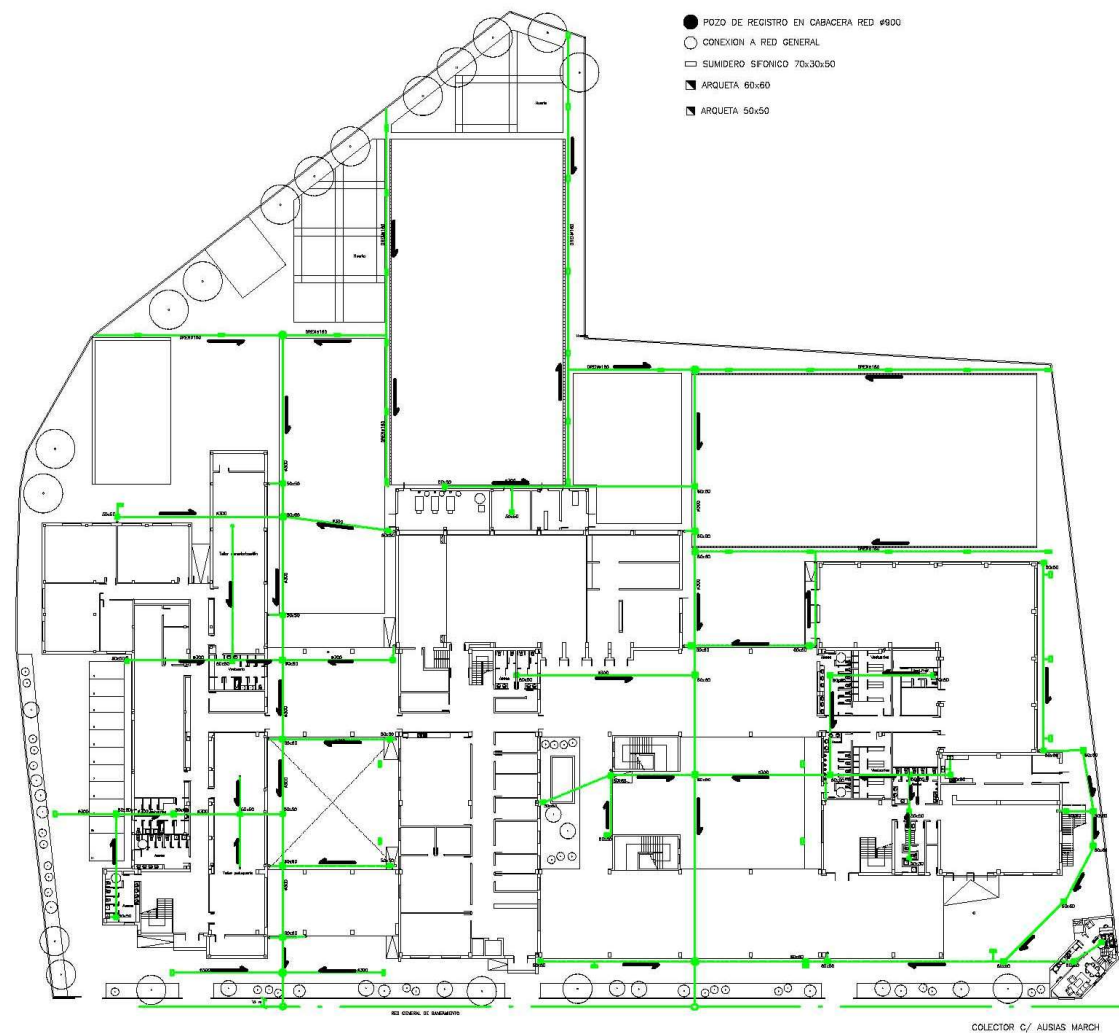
Plano de saneamiento planta baja (Fuente Proyecto)
